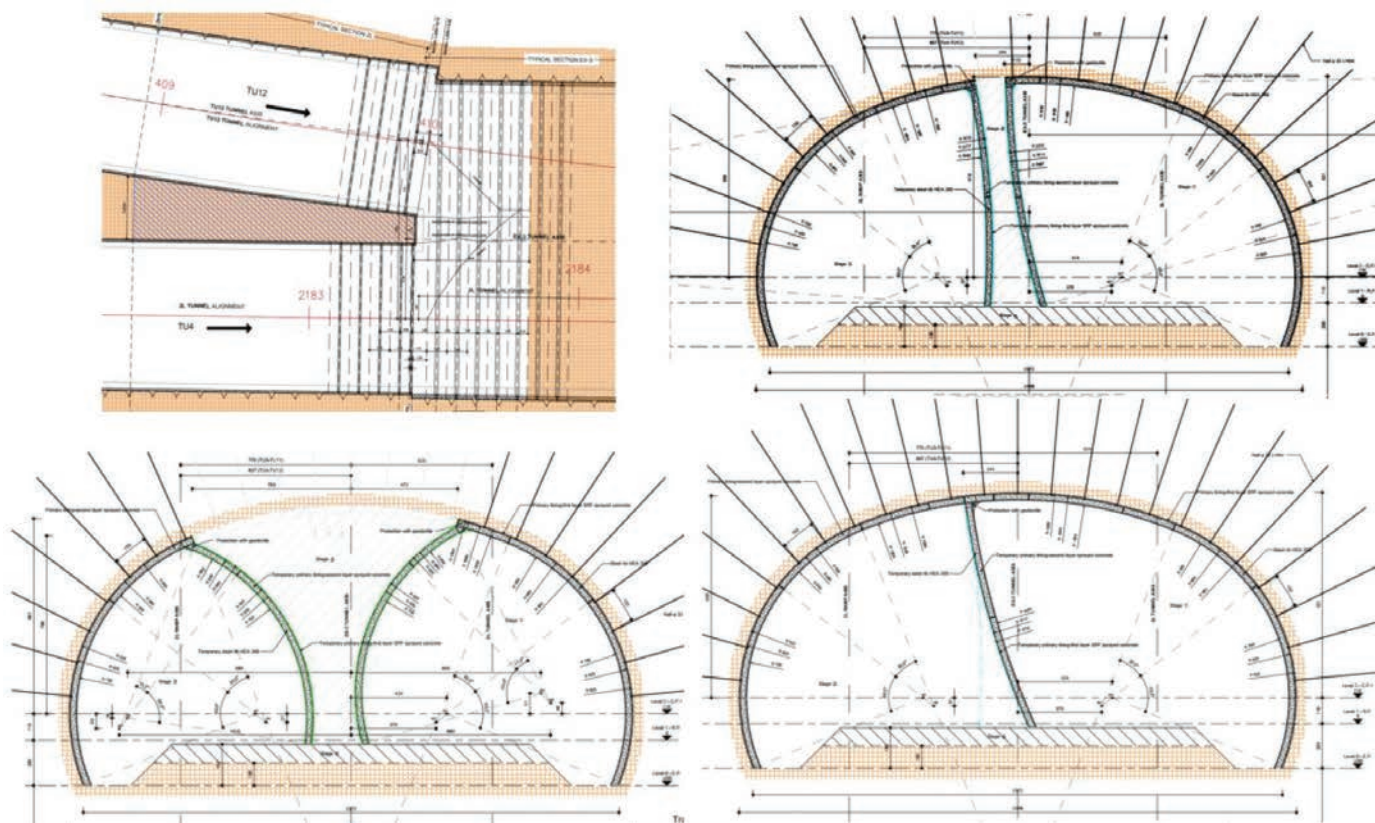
Sezioni di scavo per la transizione dalla sezione 2L alla sezione EX-3.
